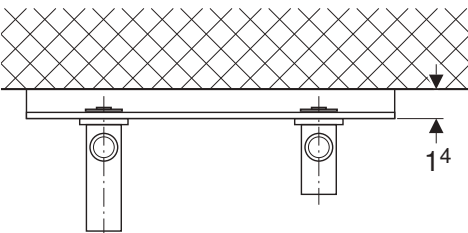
Dimensões de montagem para montagem exterior com placa de montagem Geberit reta
